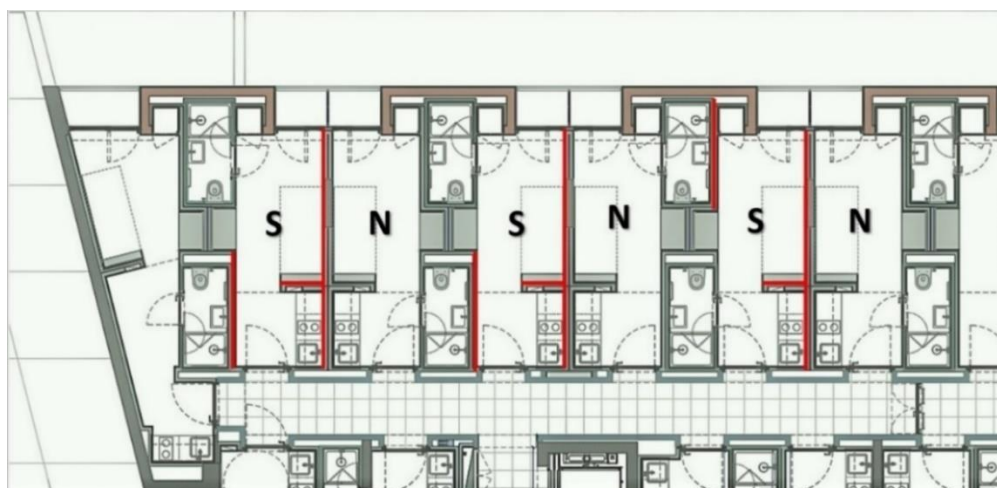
Áreas de intervenção Fase 1 - Zona vermelha (Adaptado de: Planta Piso Tipo – Anexo V)
